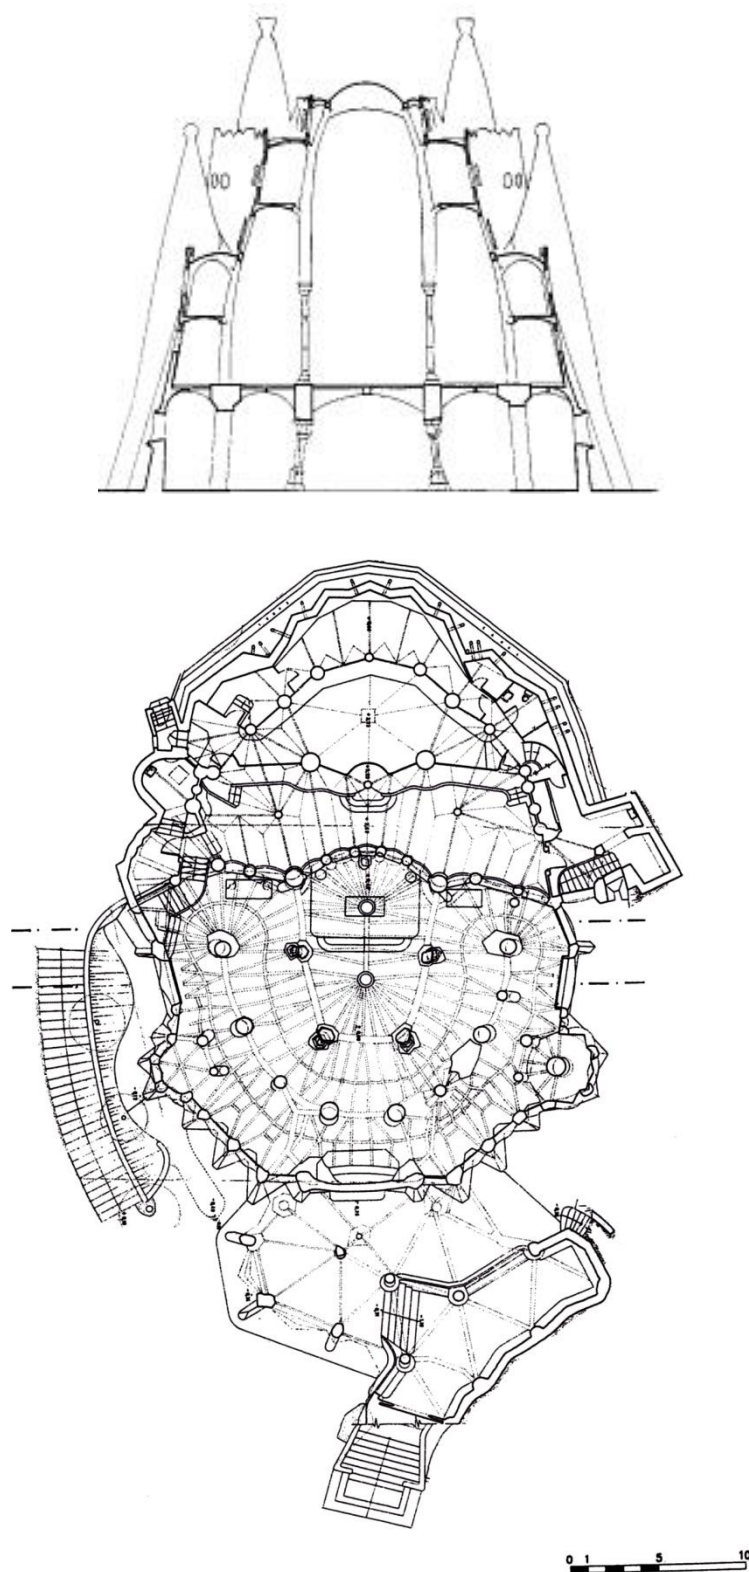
Planta de la Cripta de la Colonia Güell. Arriba, sección mostrando la construcción superior no realizada y que llevaría al equilibrio de las pilastras con apariencia de desequilibrio.
